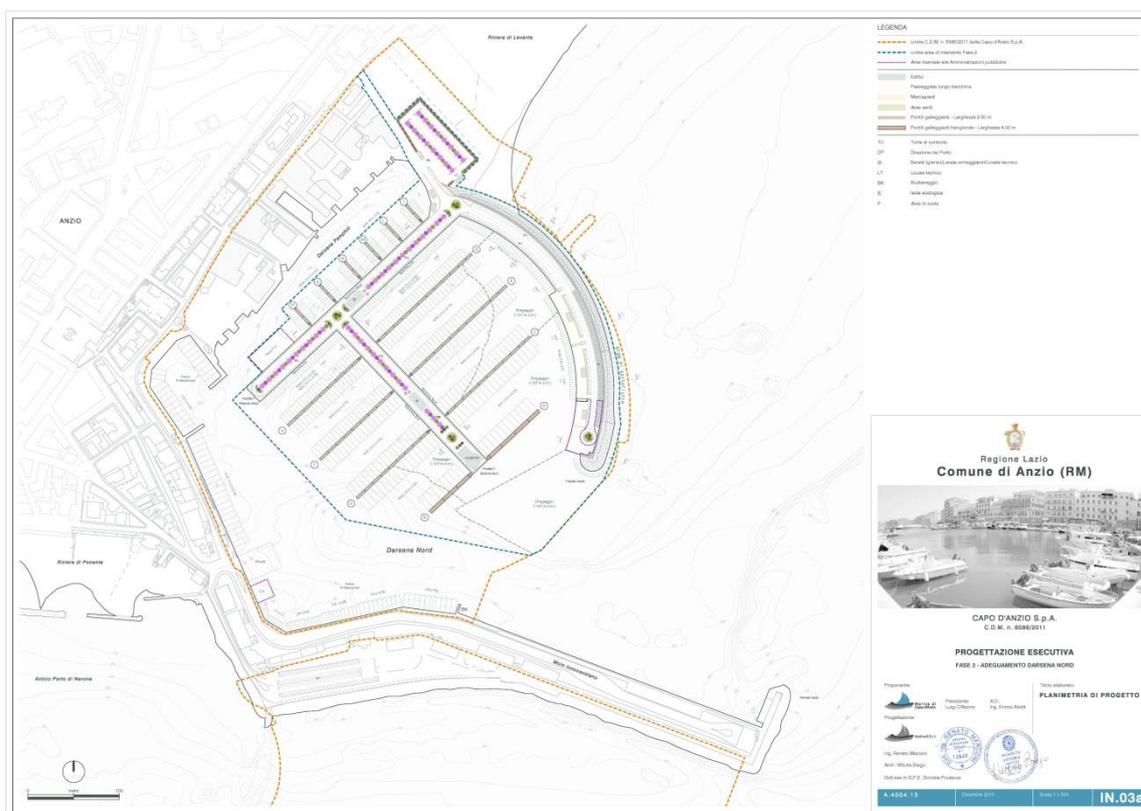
Elab. grafico IN.03a – Planimetria di progetto
